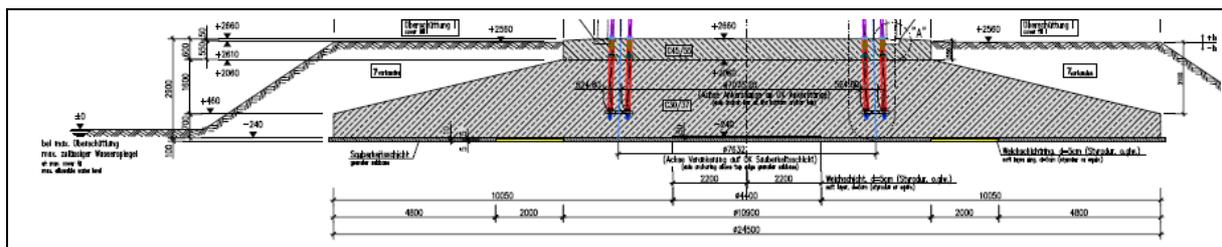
Schnittdarstellung Fundament Vestas V 162 5,6MW mit 169mNH
